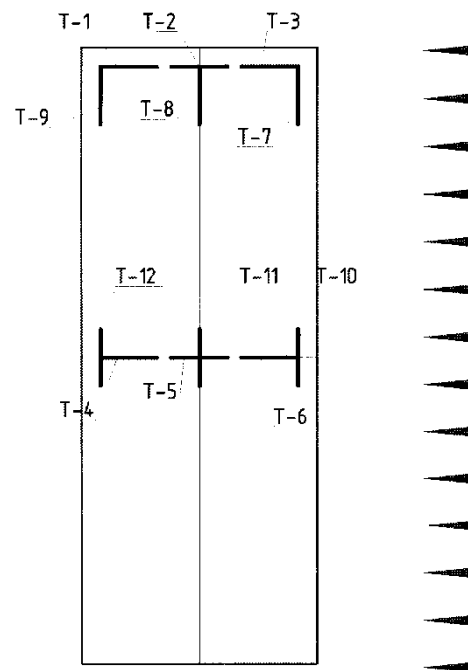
Схема испытания сталефибробетонных призм на сжатие в условиях нагрева:
